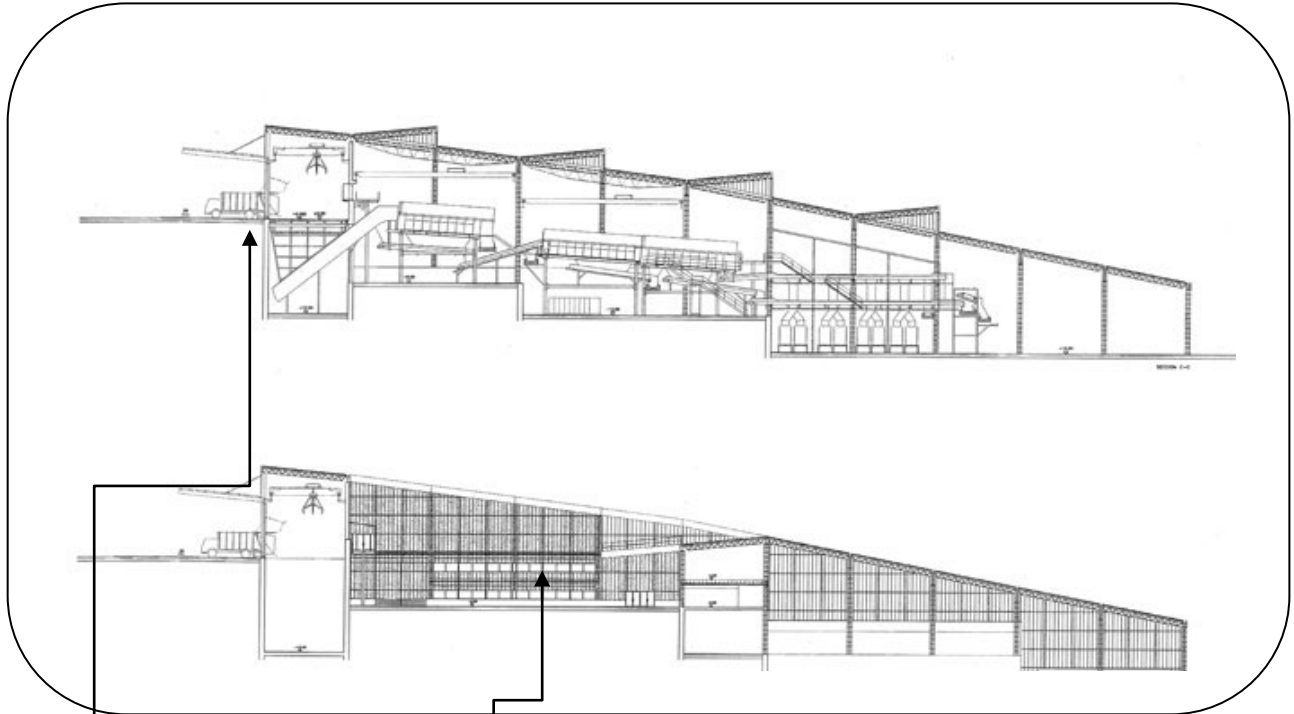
Se observan los cortes de la planta, donde vemos tanto el recorrido de la materia, como la estructura y sus fachadas de vidrio interior, aprovechamiento del terreno, para la
